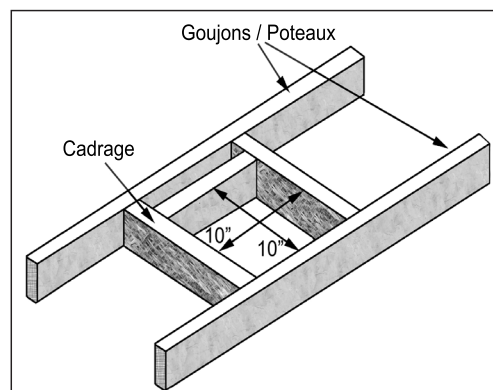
Encadrement de l'événement pour le mur ou plafond.
